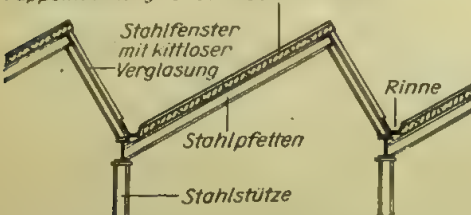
Shedhalle mit schräger Verglasung
